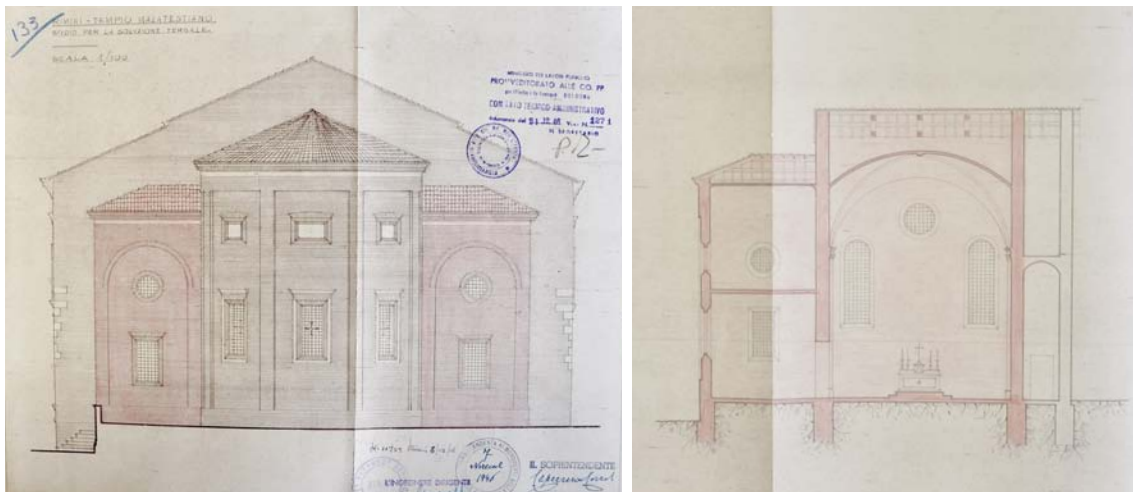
| Progetto zona absidale. Prospetto e sezione trasversale; visibile il solaio “tipo Varese”
